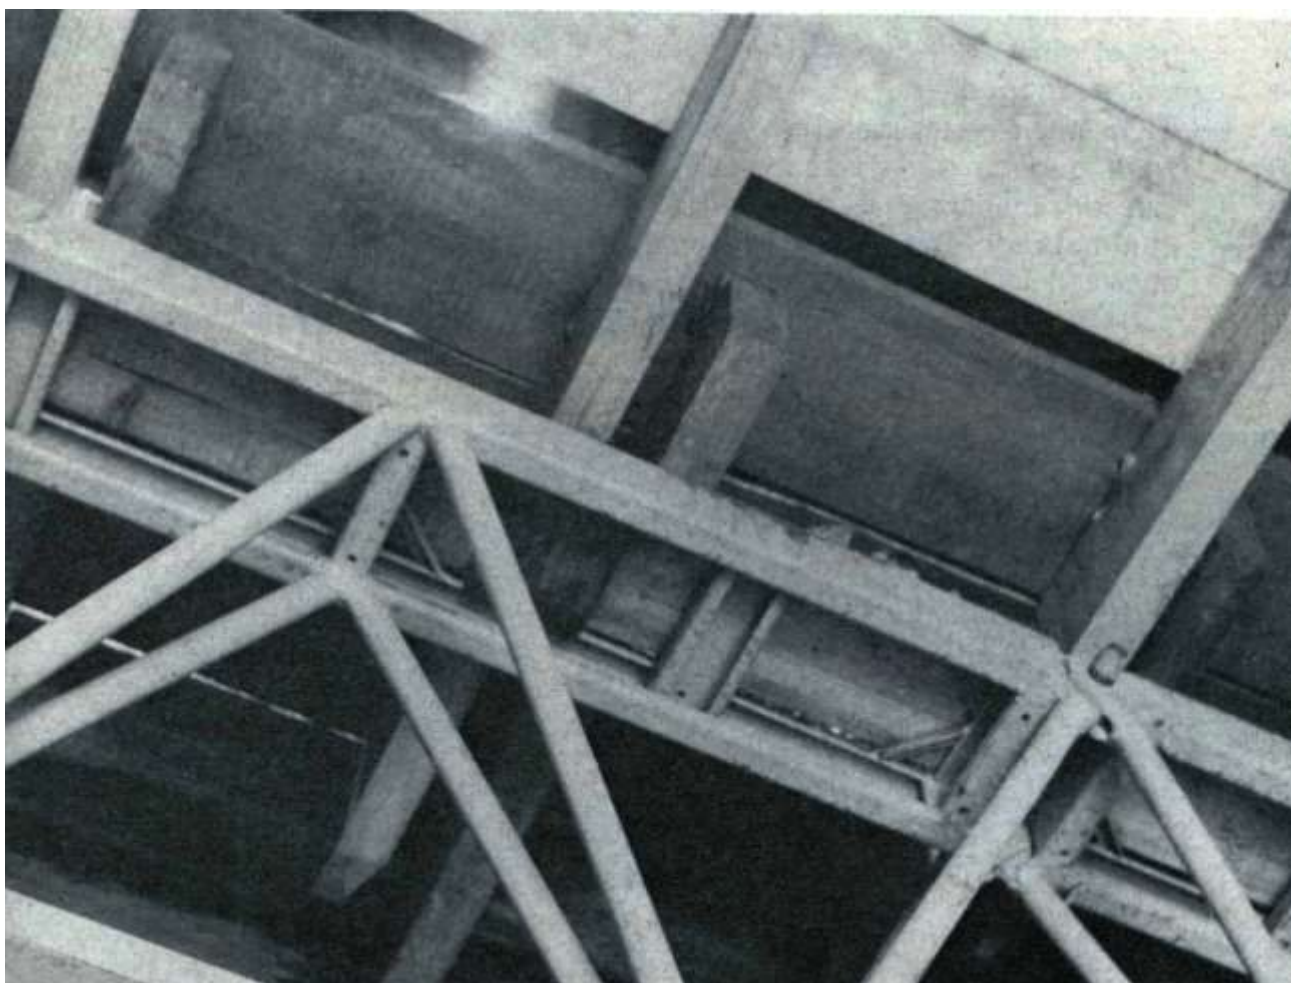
Plancher rétractable de la plateforme du coffrage coulissant.
